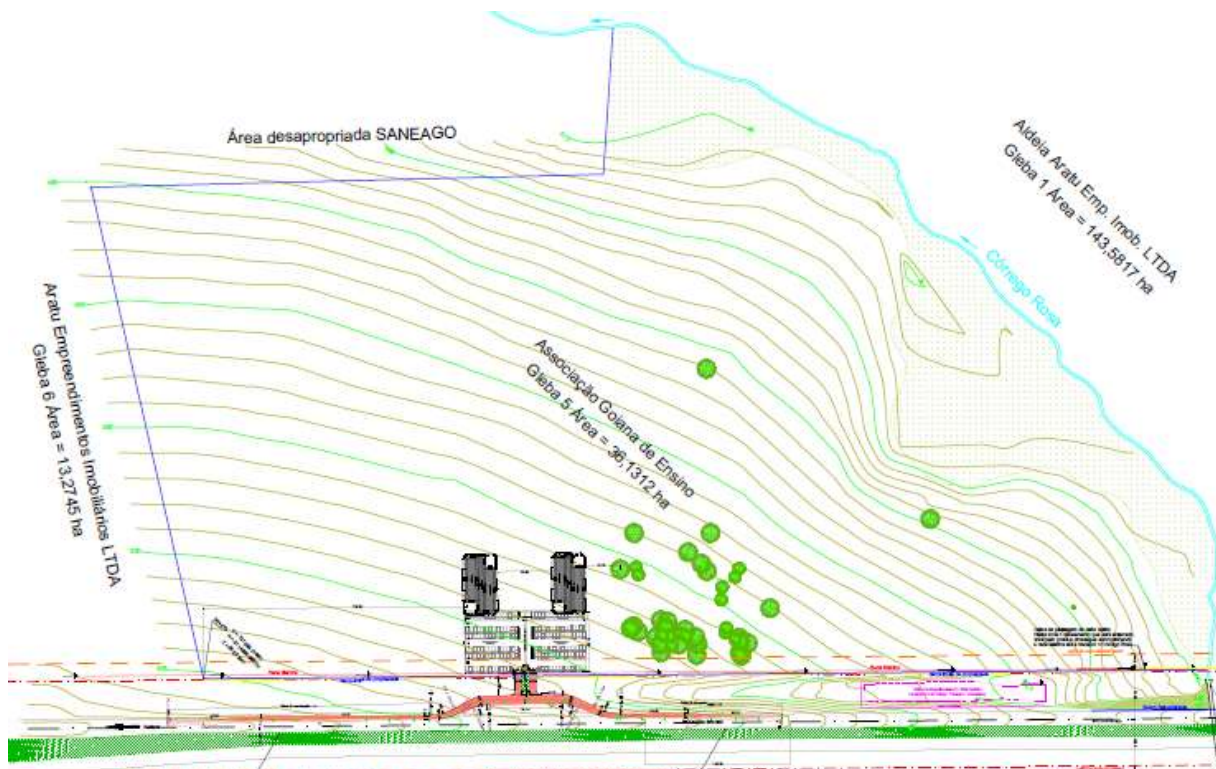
Planta Baixa das Futuras Instalações do Campus II do Centro Universitário de Goiás Uni-Anhanguera.
